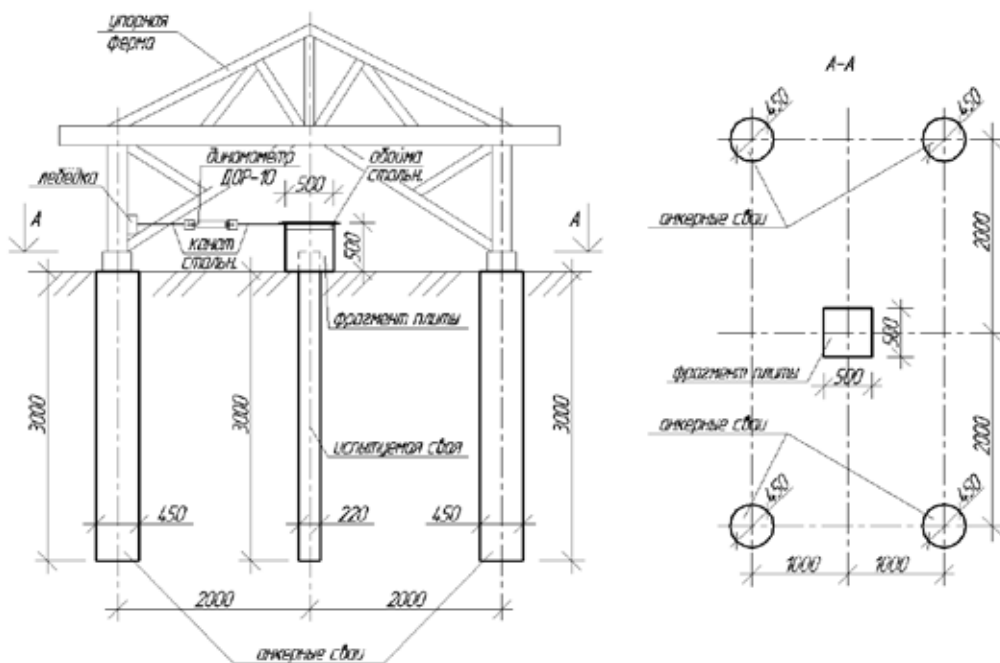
Схема установки для испытания сваи статической горизонтальной нагрузкой
